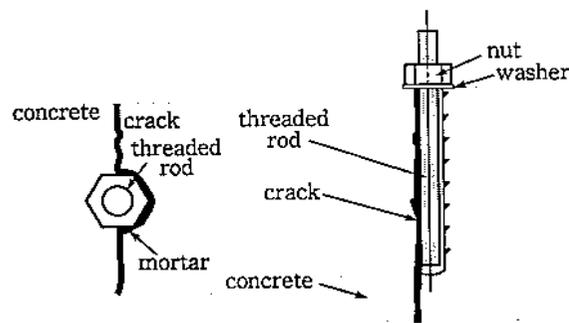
ひび割れが接着系アンカーボルトに及ぼす影響¹⁸⁾
